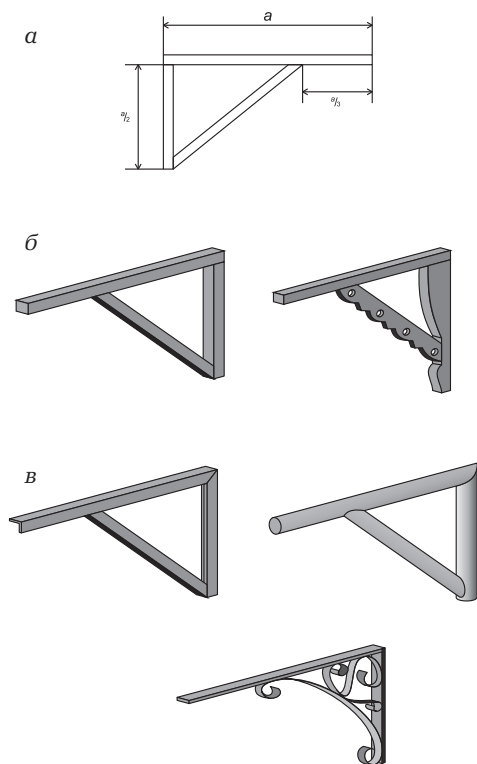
Кронштейны Г-образной формы: а — общая схема; б — из древесины; в — из металла
